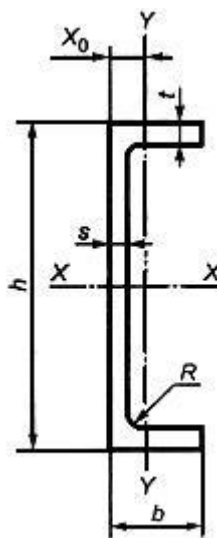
Эскиз швеллера с параллельными гранями полок [3]
